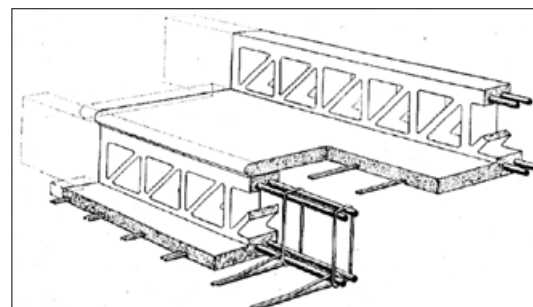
Stufenanlage nach dem System Visentini (Beton und Eisen 1903, S. 160).
